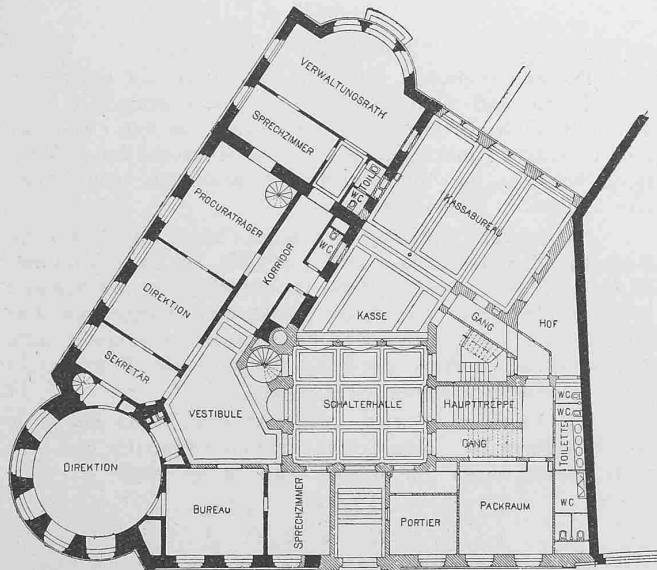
Handelsbank nach dem Umbau. Grundriss vom Erdgeschoss. Masstab 1 : 400.
